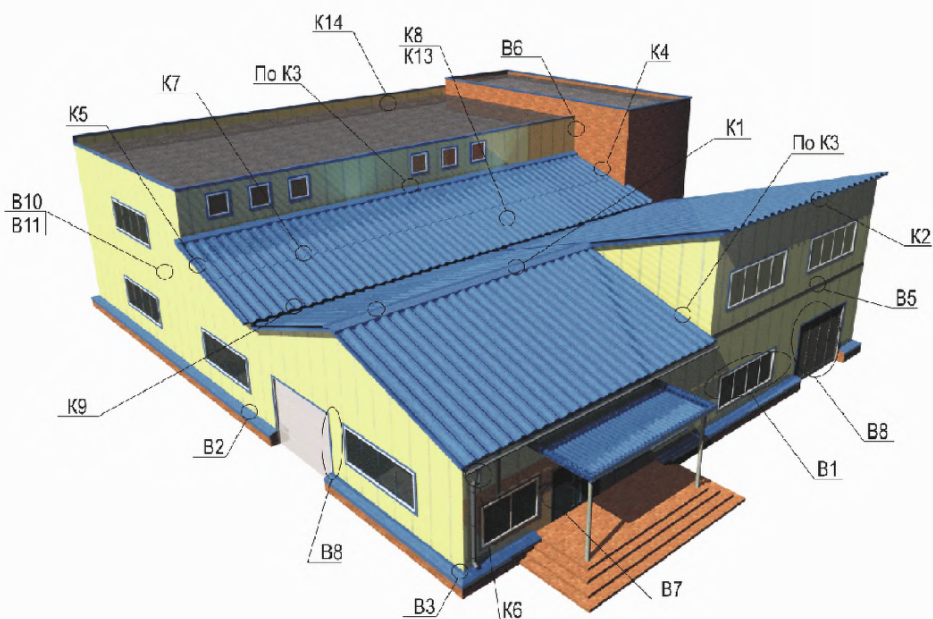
а – Здание с вертикальной раскладкой стеновых панелей
